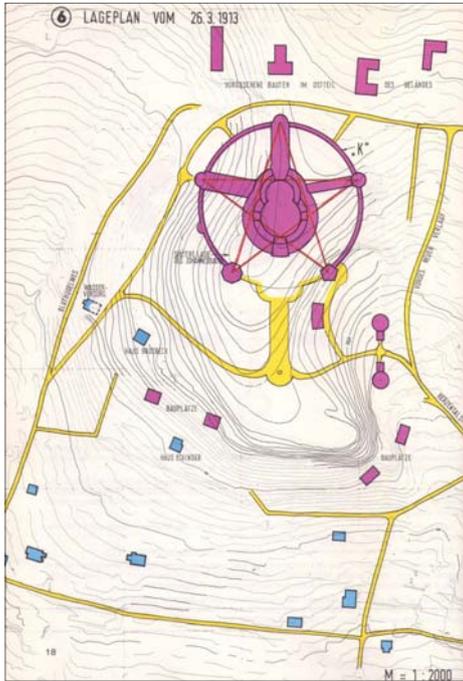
Rudolf Steiner - Planimetria terreno collina di Dornach, Progetto del 26.3.1913. Dornach, Svizzera.
